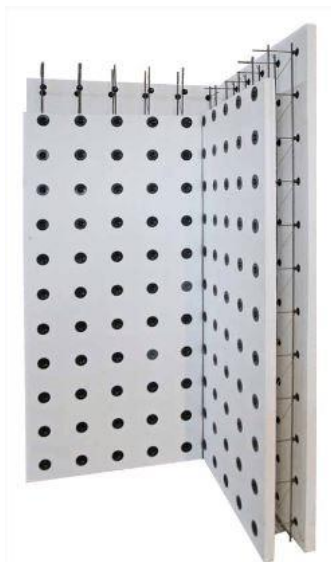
Каркас стены по технологии PLASTBAU [105]
